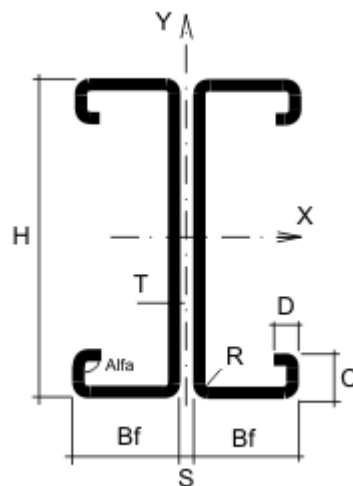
Двойной С-образный профиль с двойными отгибами
